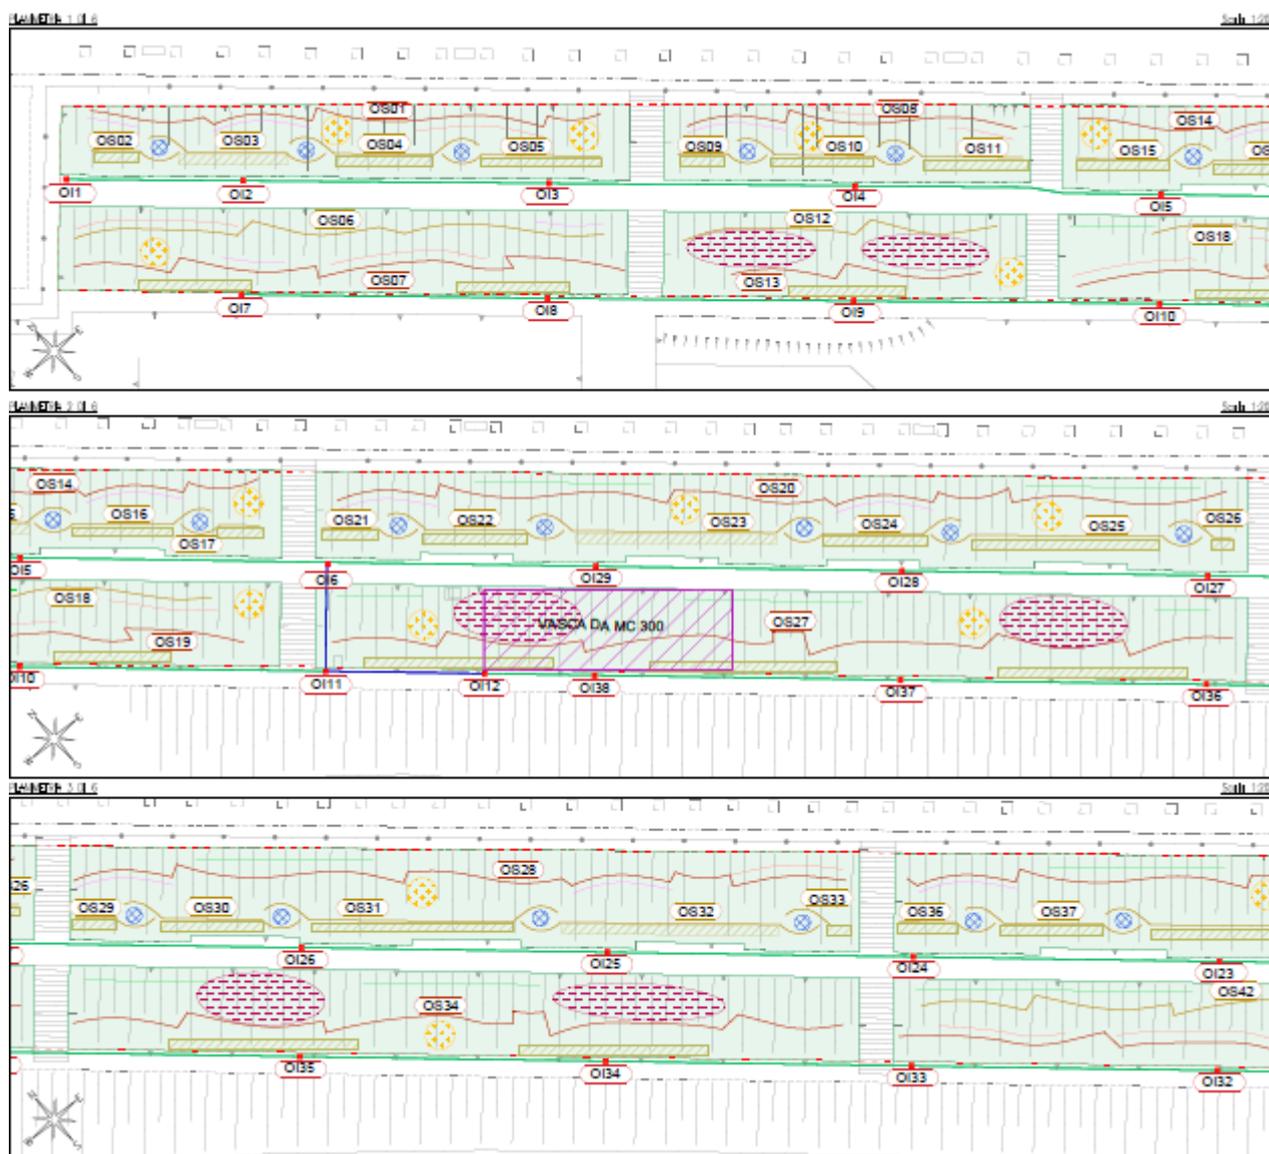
Estratto elaborato Planimetria generale di progetto (1 di 2)
